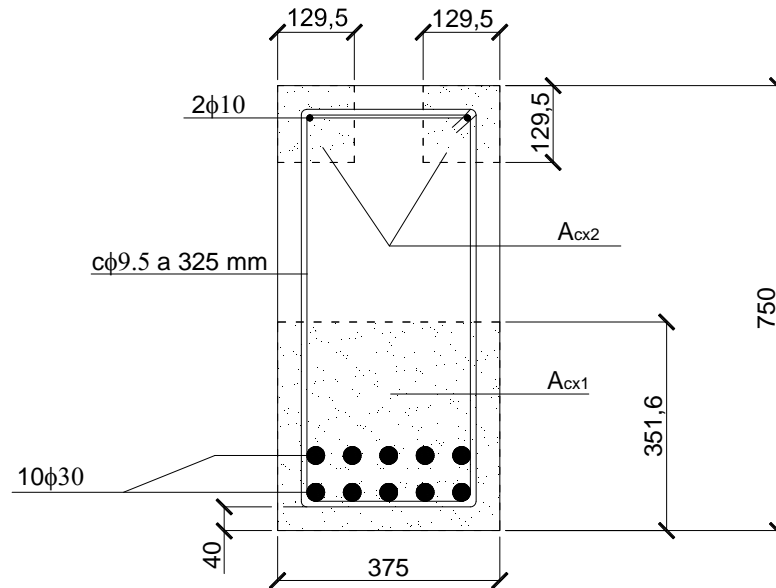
Sección transversal del espécimen N2-N. Detalle de las áreas efectivas de la armadura pasiva longitudinal, según el criterio definido en el MC 1990. Cotas en mm.
